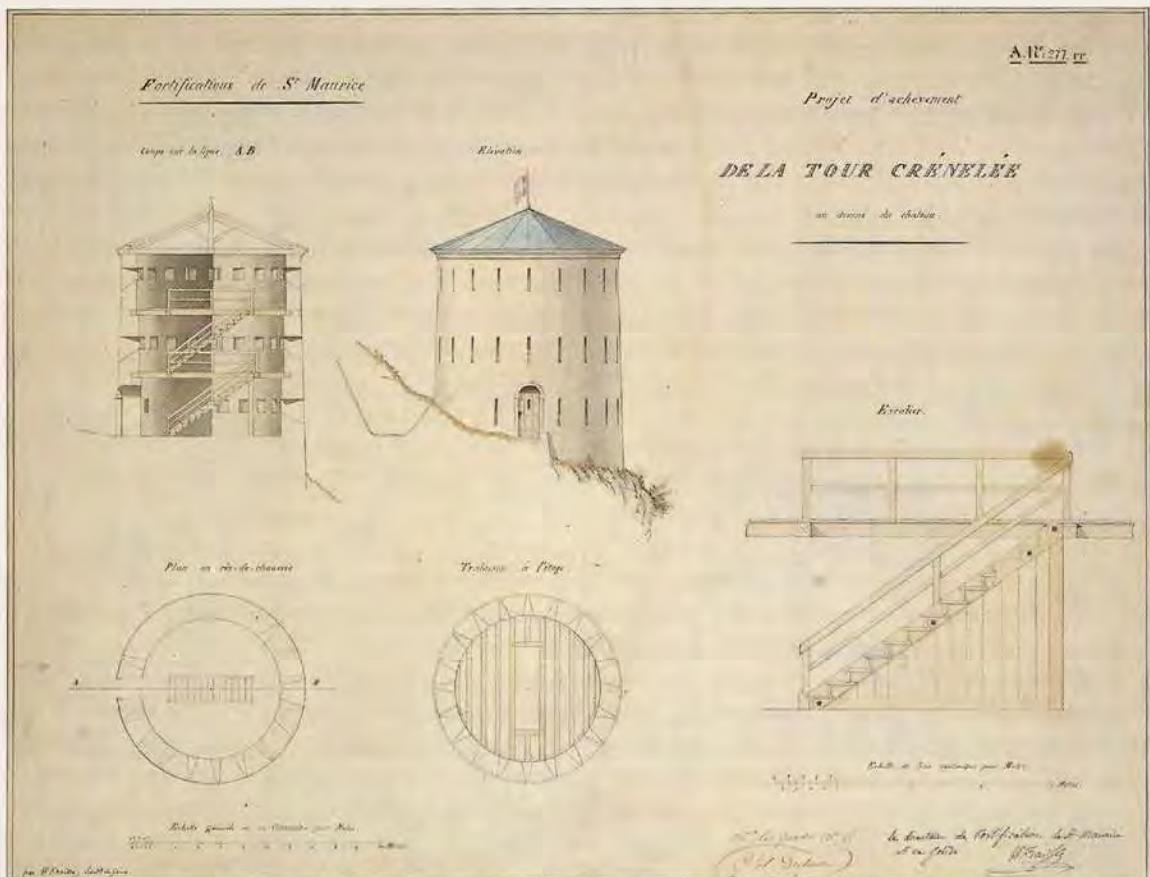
Projet d'exhaussement de la tour crênelée, 1848. Ech. appr.: 1:300. Office du génie et des fortifications, Berne.
